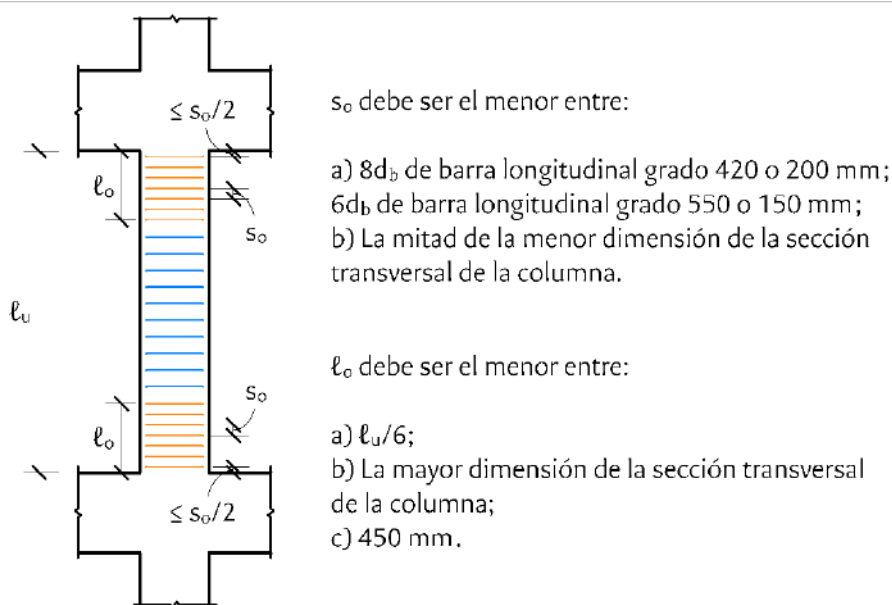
Estribos cerrados de confinamiento en columnas intermedias.
